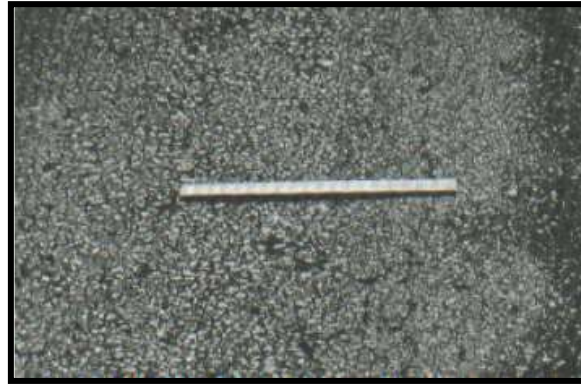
Nivel de Severidad Bajo de Meteorización en el Pavimento.
